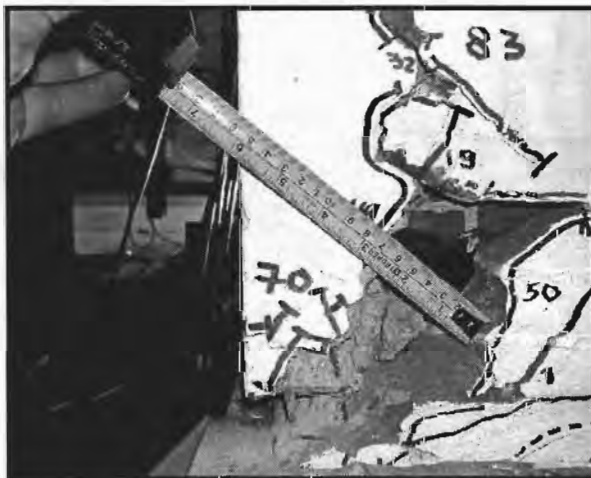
Estado final de daño en el modelo (fachada Norte)
